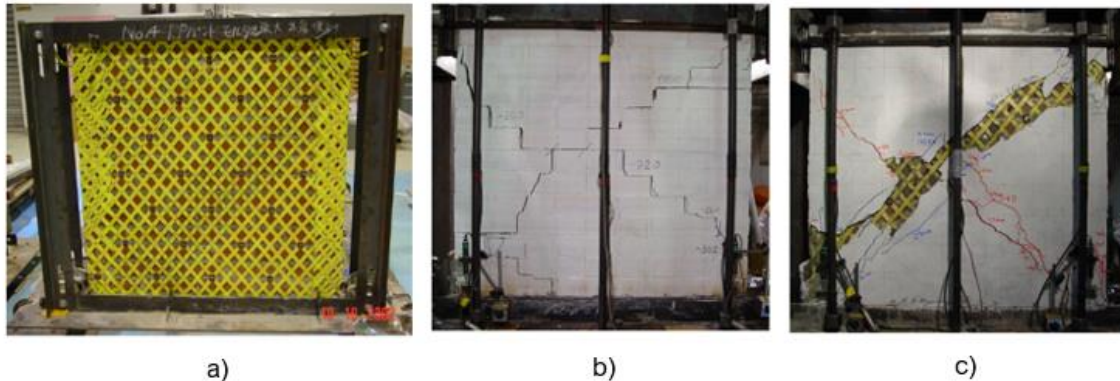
a) Colocación del refuerzo en los muros b) Patrón de agrietamiento en un muro sin refuerzo c) Patrón de agrietamiento en un muro reforzado (Mayorca, 2003).
